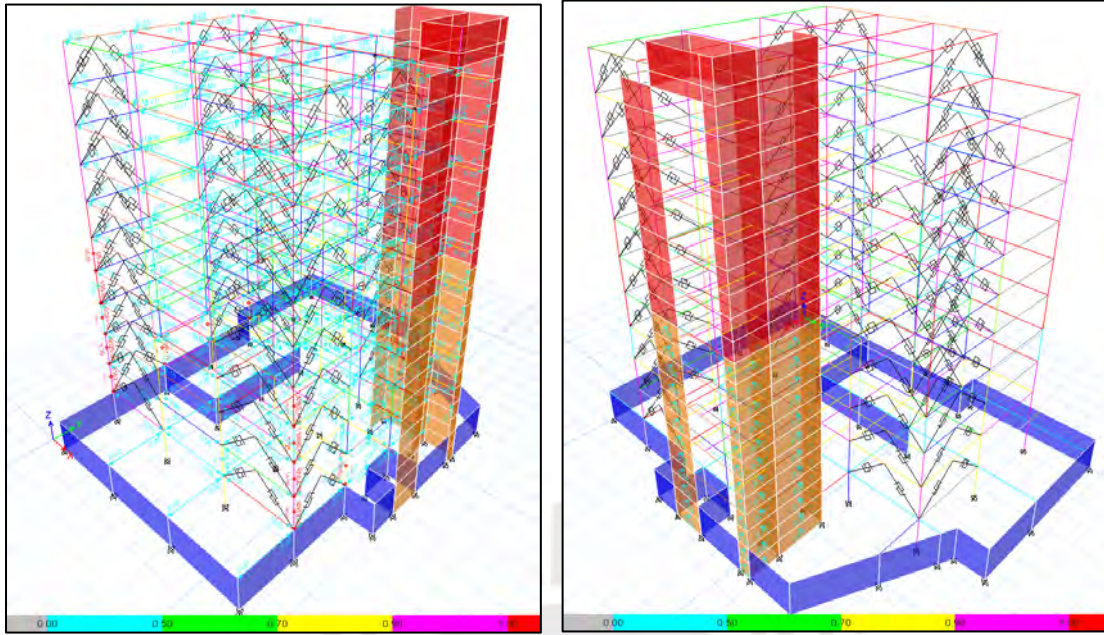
Imágenes de las vigas, columnas y placas para Prevención de Colapso
